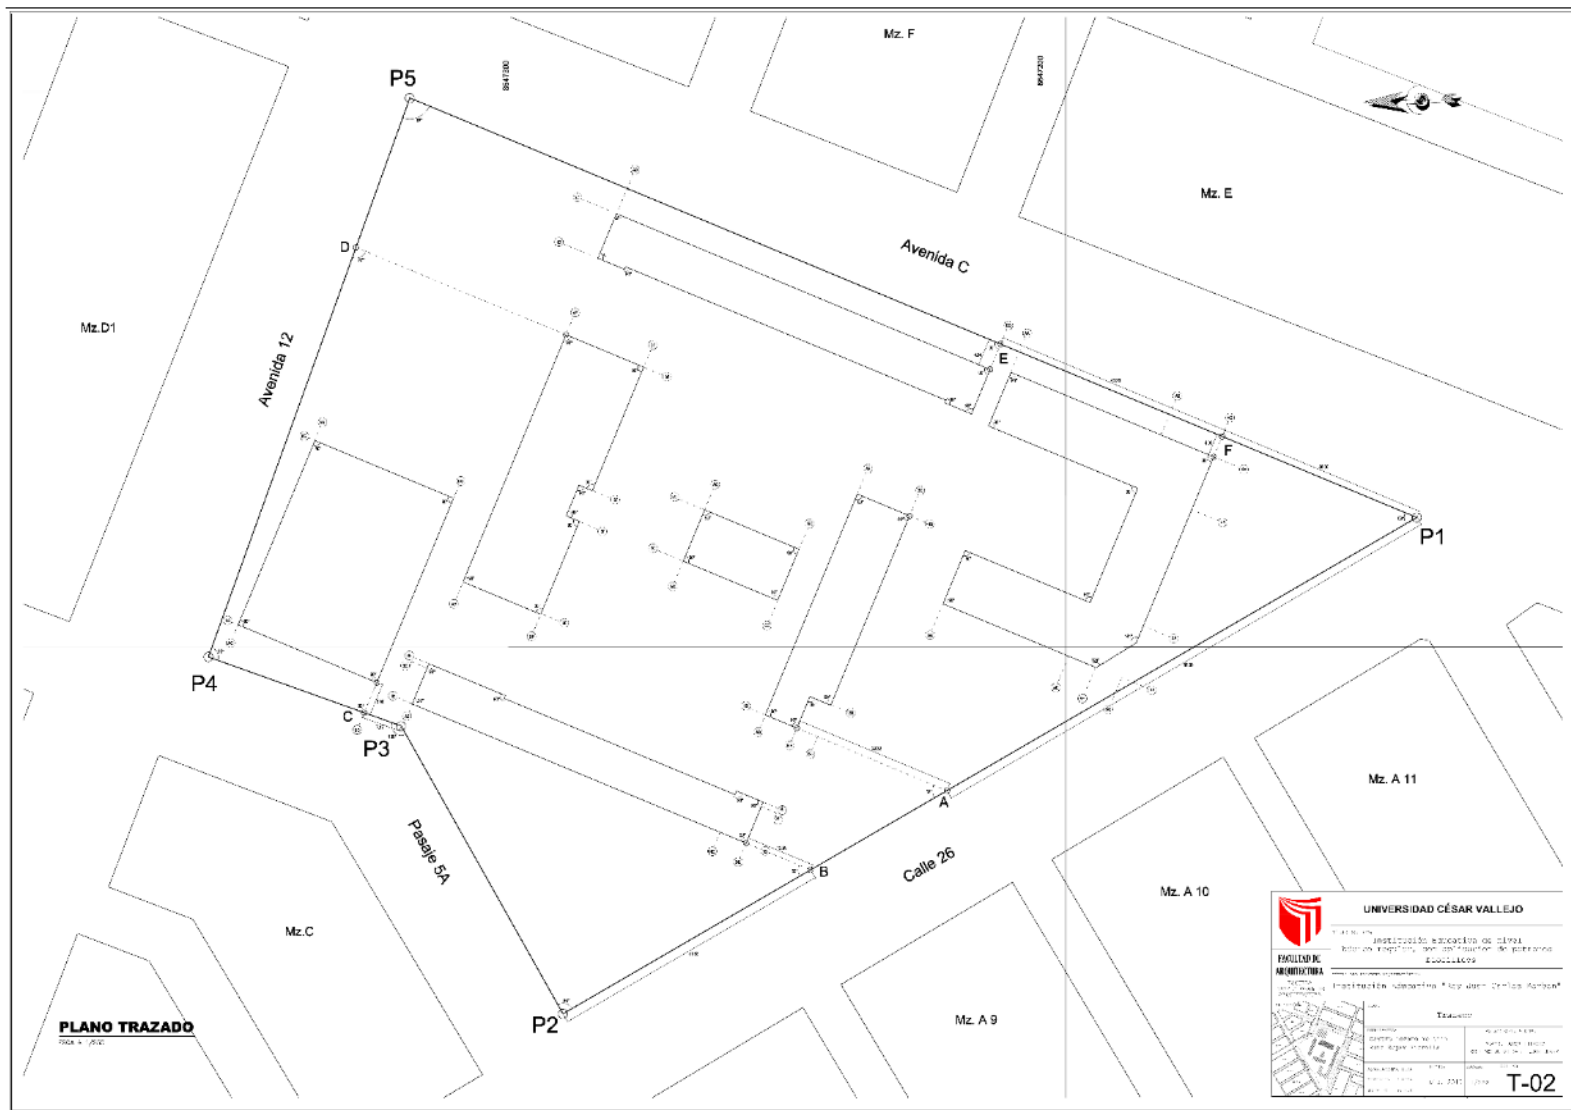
Plano de Trazado, Fuente: elaboración propia
